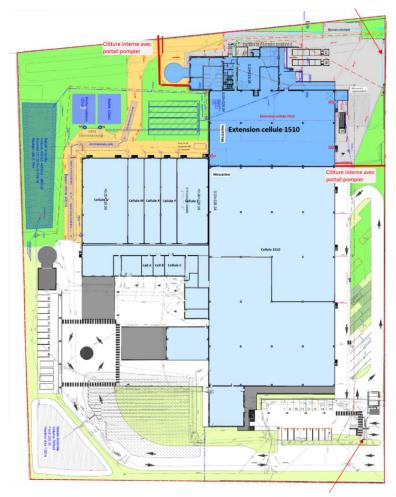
PLAN PROJETE DU SITE ECTRA (EXTENSION DE LA CELLULE 1510)
